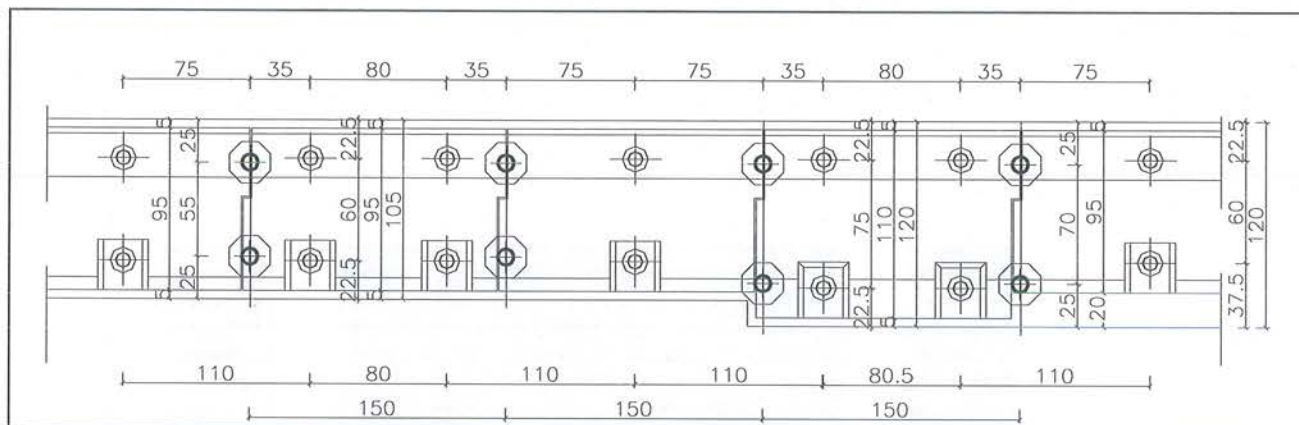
Stralcio Pianta fondazioni basamento prefabbricato
